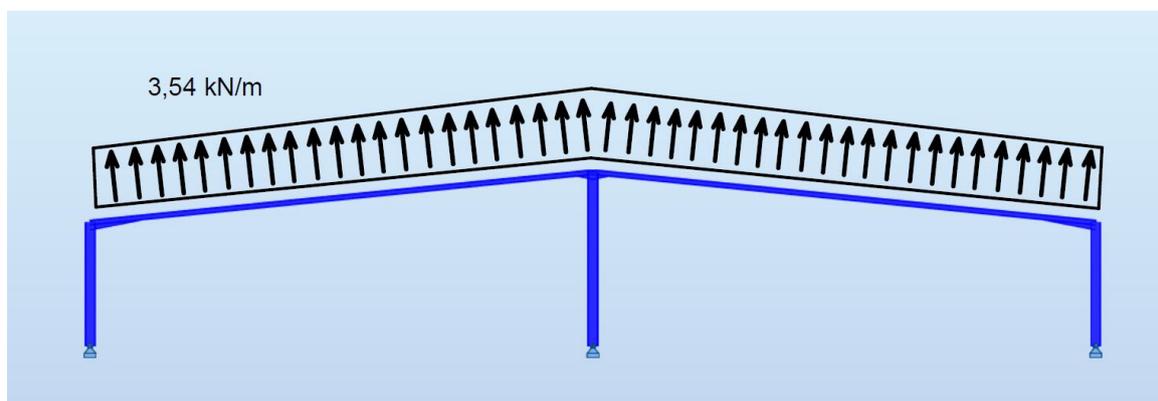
REPRESENTACIÓN PÓRTICO INTERIOR EN ZONA H PARA CARGAS CON DIRECCIÓN LONGITUDINAL A LA CUBIERTA
